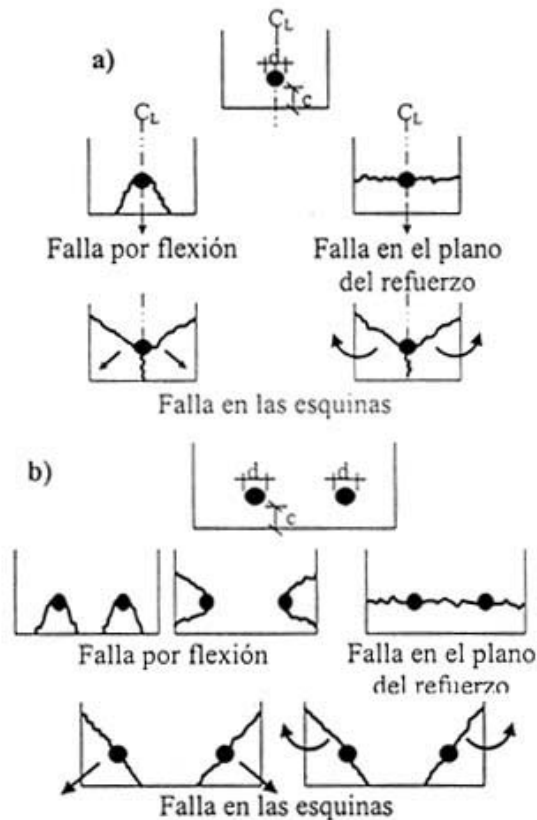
Mecanismos de fallas y desplazamientos del concreto en a) una barra anclada y b) dos barras ancladas en concreto [32]
